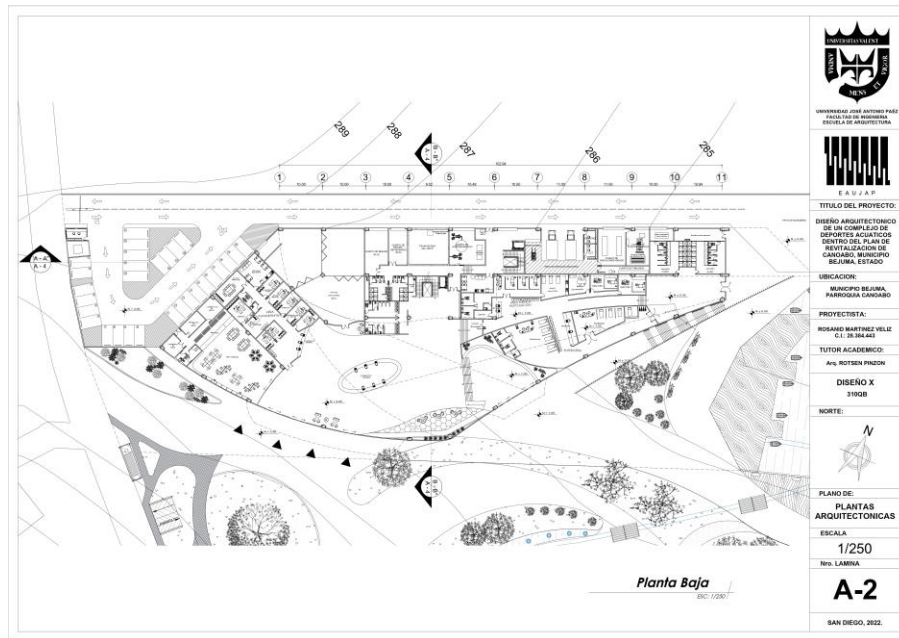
Planta Baja Nivel +0.00. Fuente: La autora (2022).
